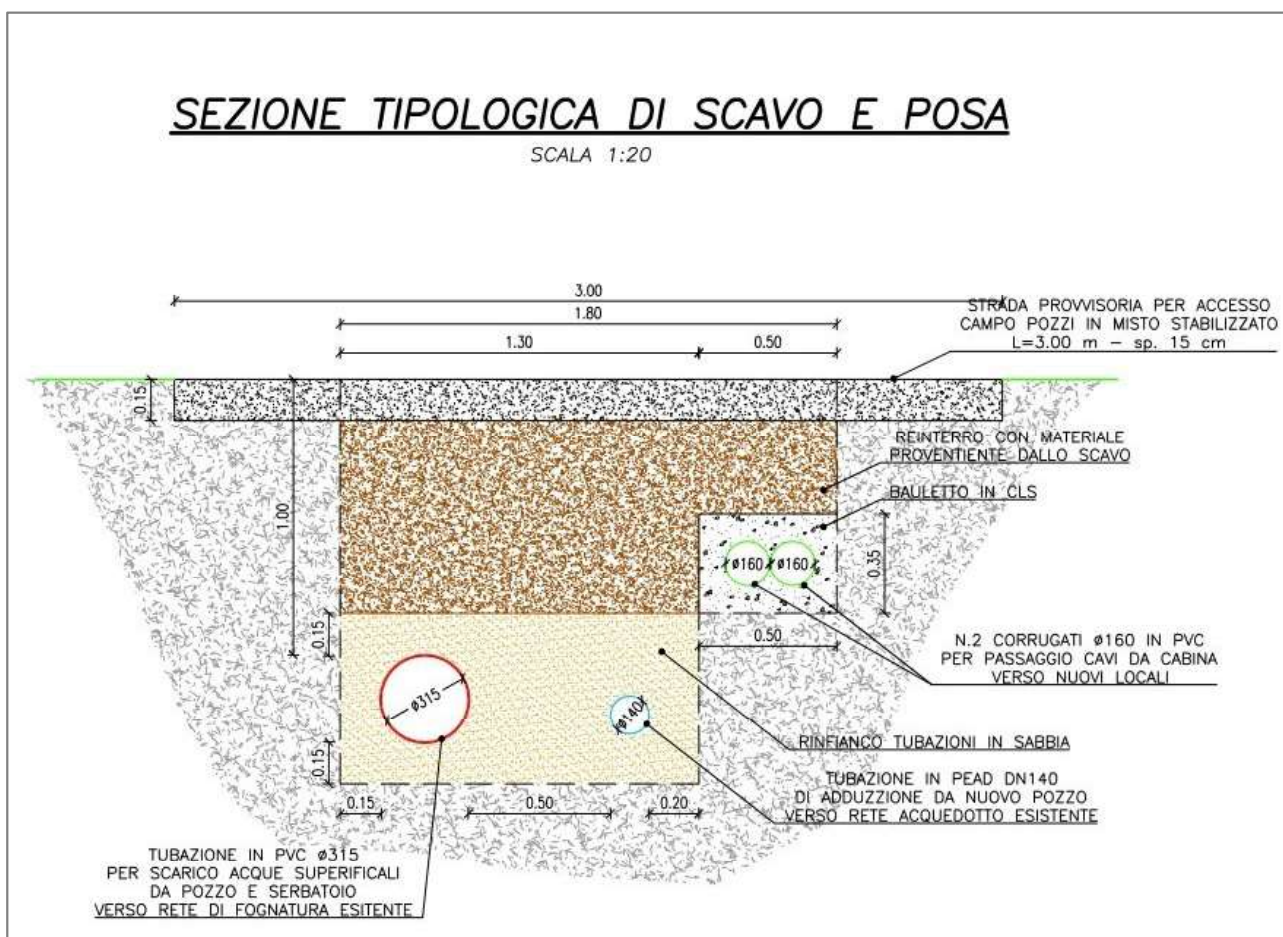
Sezione tipologica di scavo e posa, secondo il progetto
